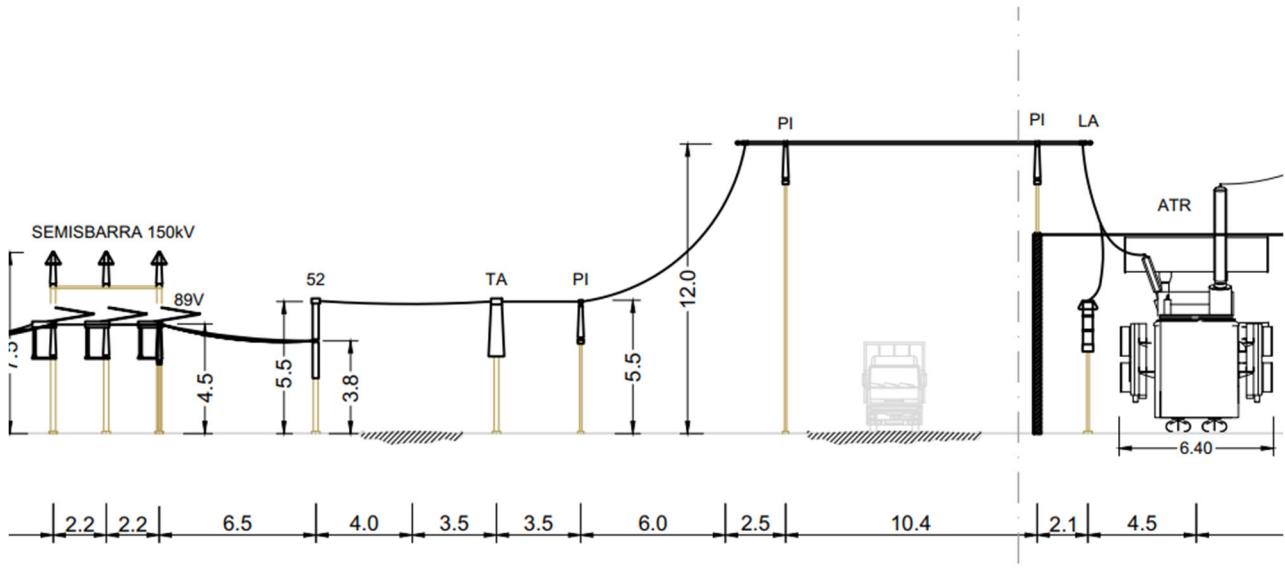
Stazione Sud – planimetria sezione 150 kV
